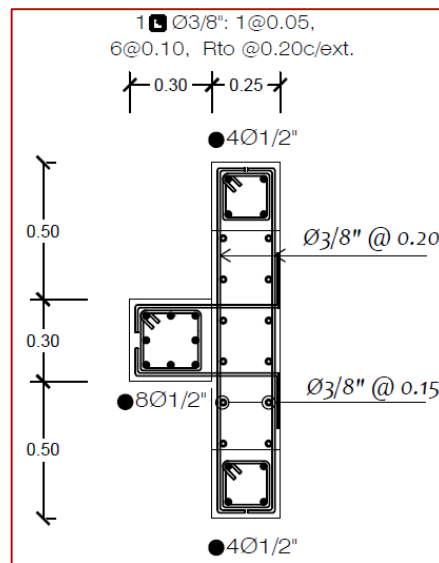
Disposición de Acero para la Placa TEE Ubicada en la Intersección de los ejes A y 4.
